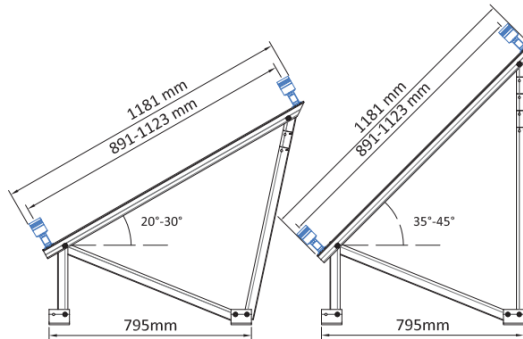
Estructura Soporte Placas Solares para Cubierta de Teja con Varilla. (Teknosolar, s.f.)
